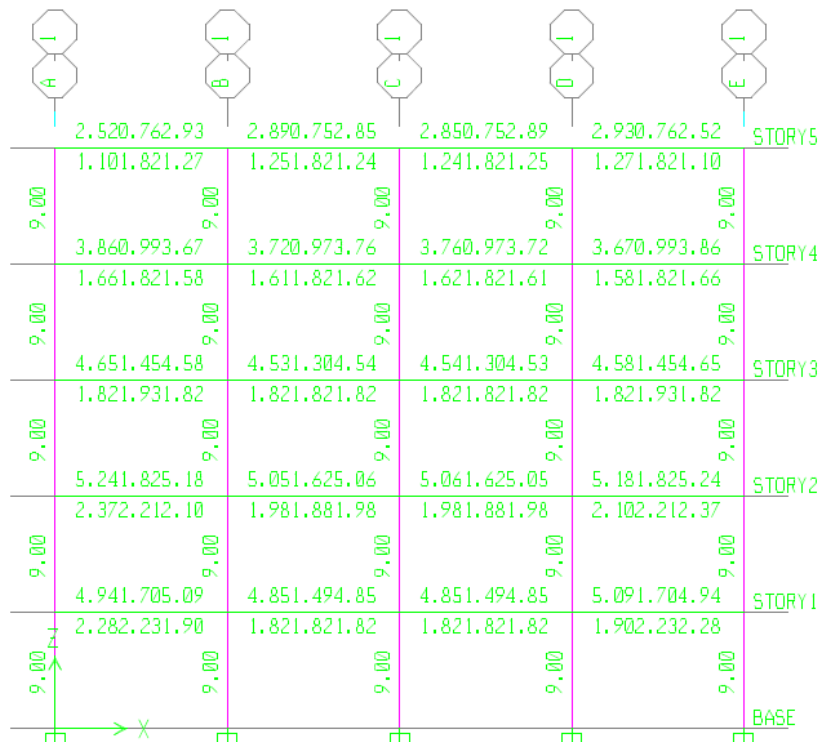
Área de acero en cm<sup>2</sup> para vigas y columnas P5 Caso 2, Fuente ; El Autor
